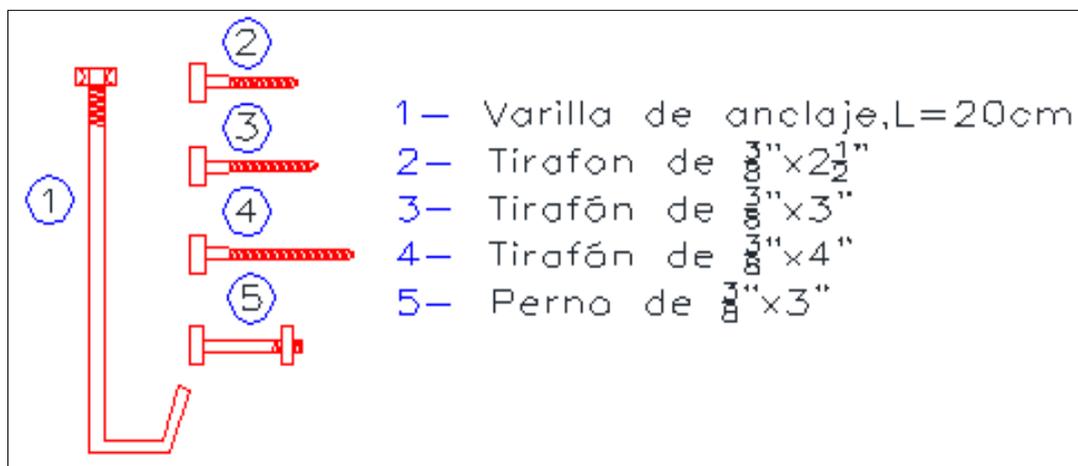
Descripción de los materiales para las conexiones entre paneles, viga solera inferior, columnas y cimentación
